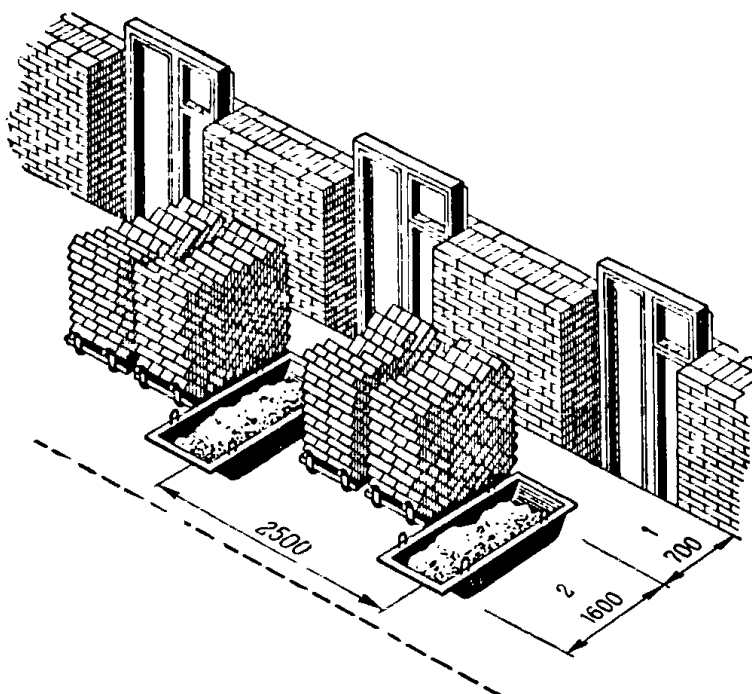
Схема размещения материалов на рабочем месте при кладке стен с проемами
